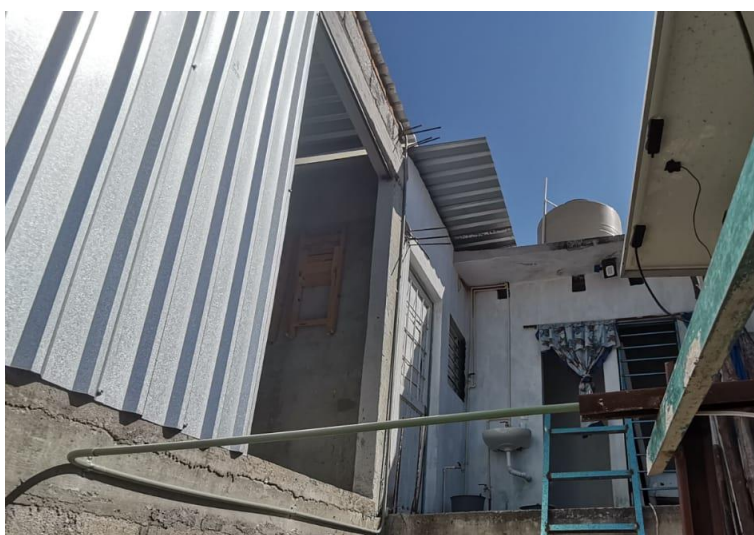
Tubo conduit instalado de la estructura metálica de los módulos a la pared.
